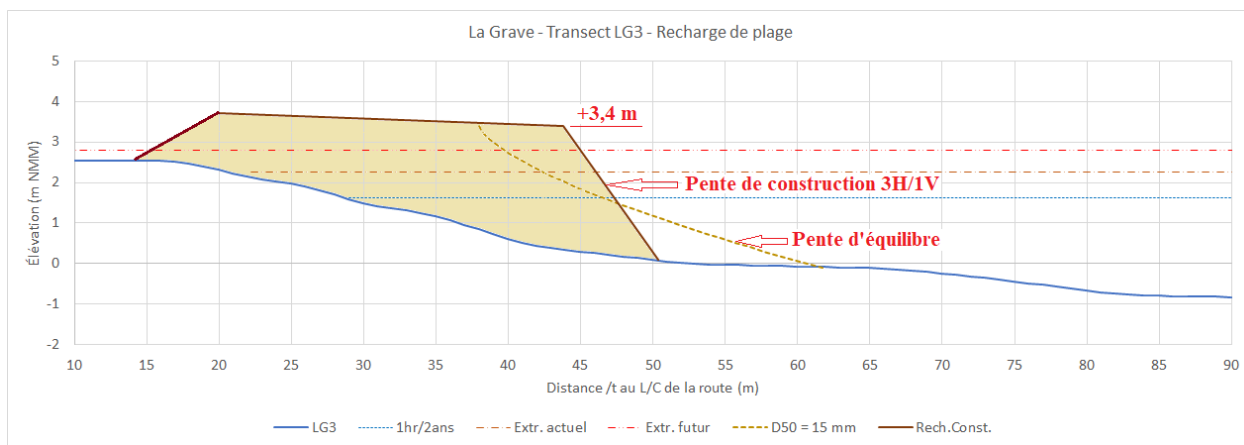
Coupe-type de rechargement de plage – Transect LG3
